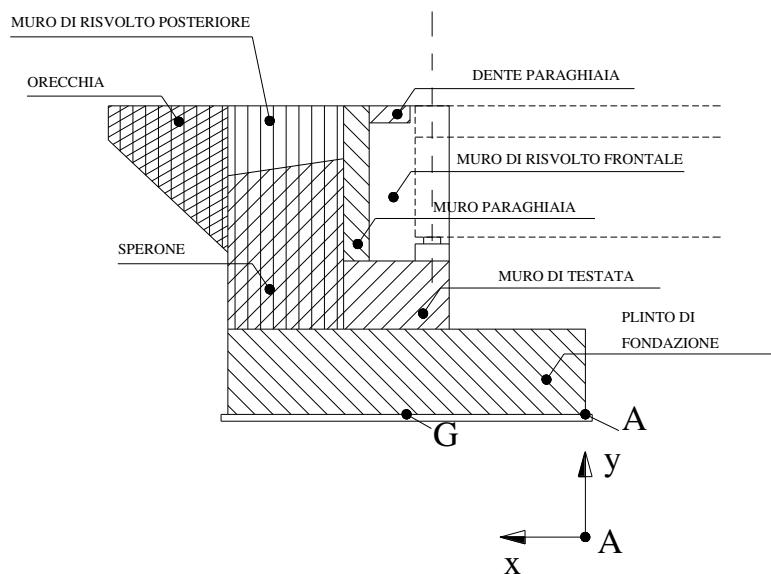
SCHEMA LONGITUDINALE SPALLA
